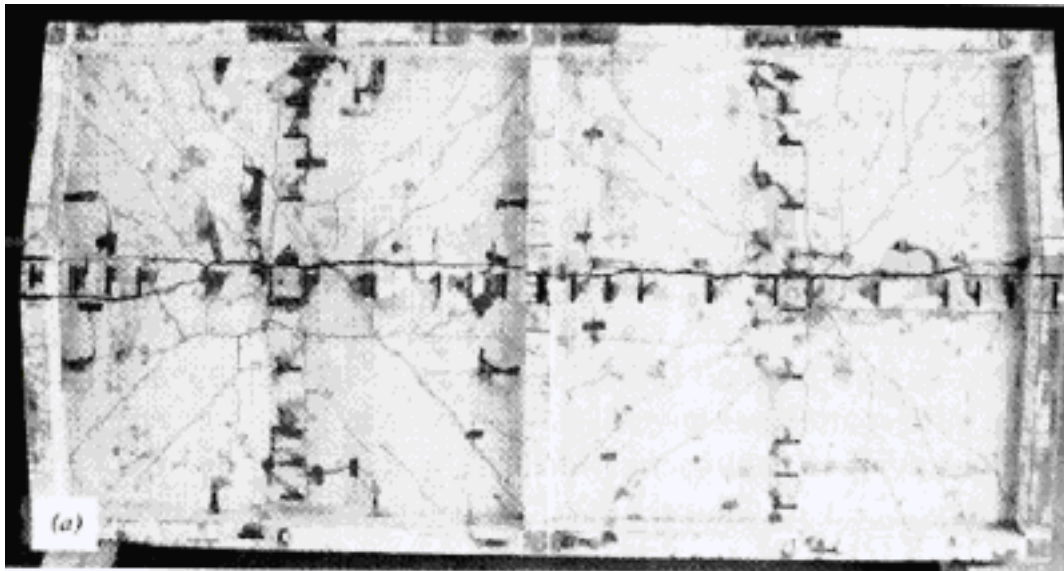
Configuração de ruína composta vigas-lajes (PARK & GAMBLE, 1980)
